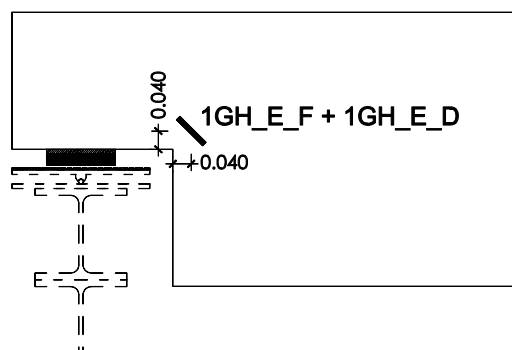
Esquema de ubicación de bandas extensométricas de hormigón
